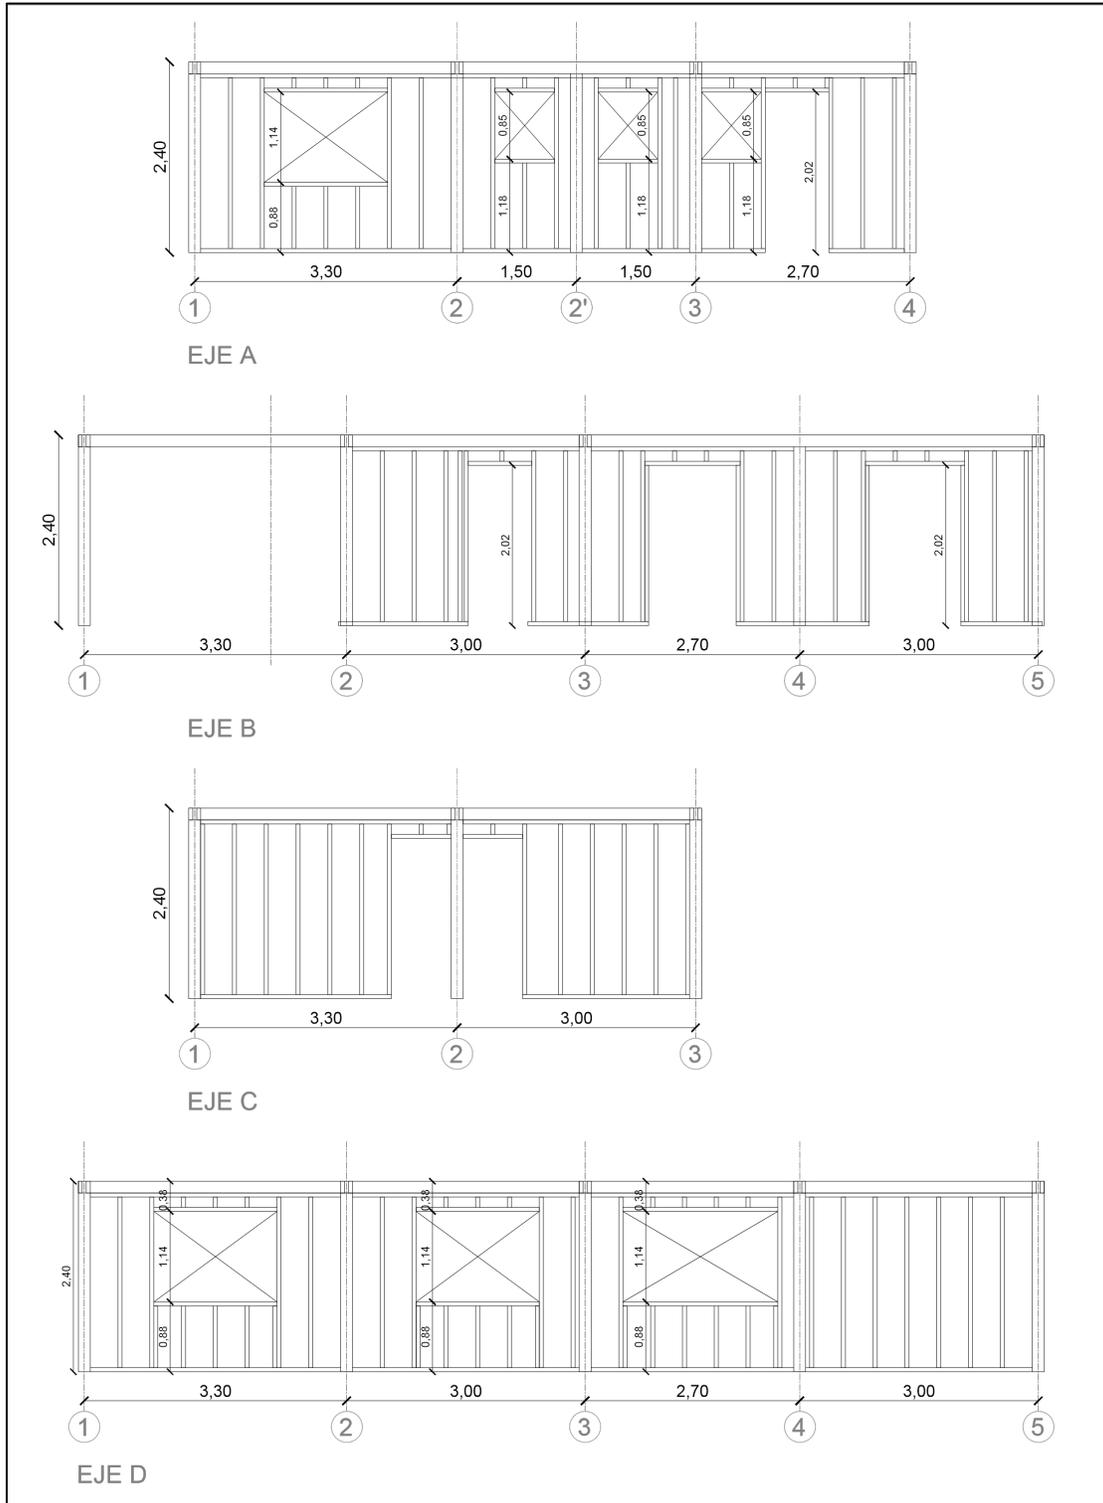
Elevaciones de estructuras modelo pilar-viga
